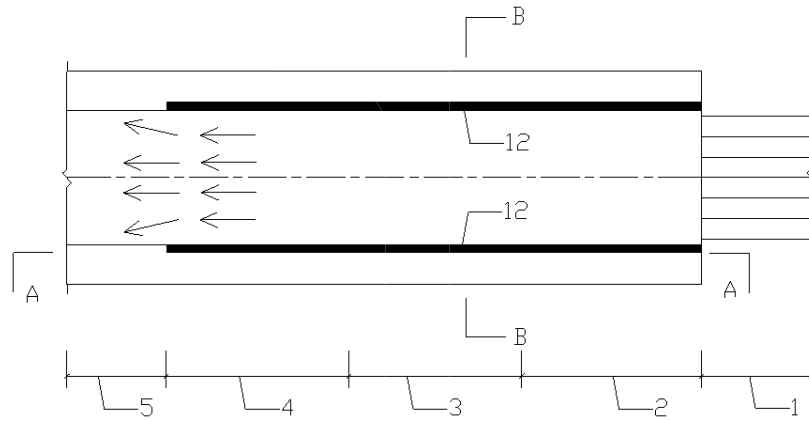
门式水泥搅拌墙处理桥头跳车方法平面图
